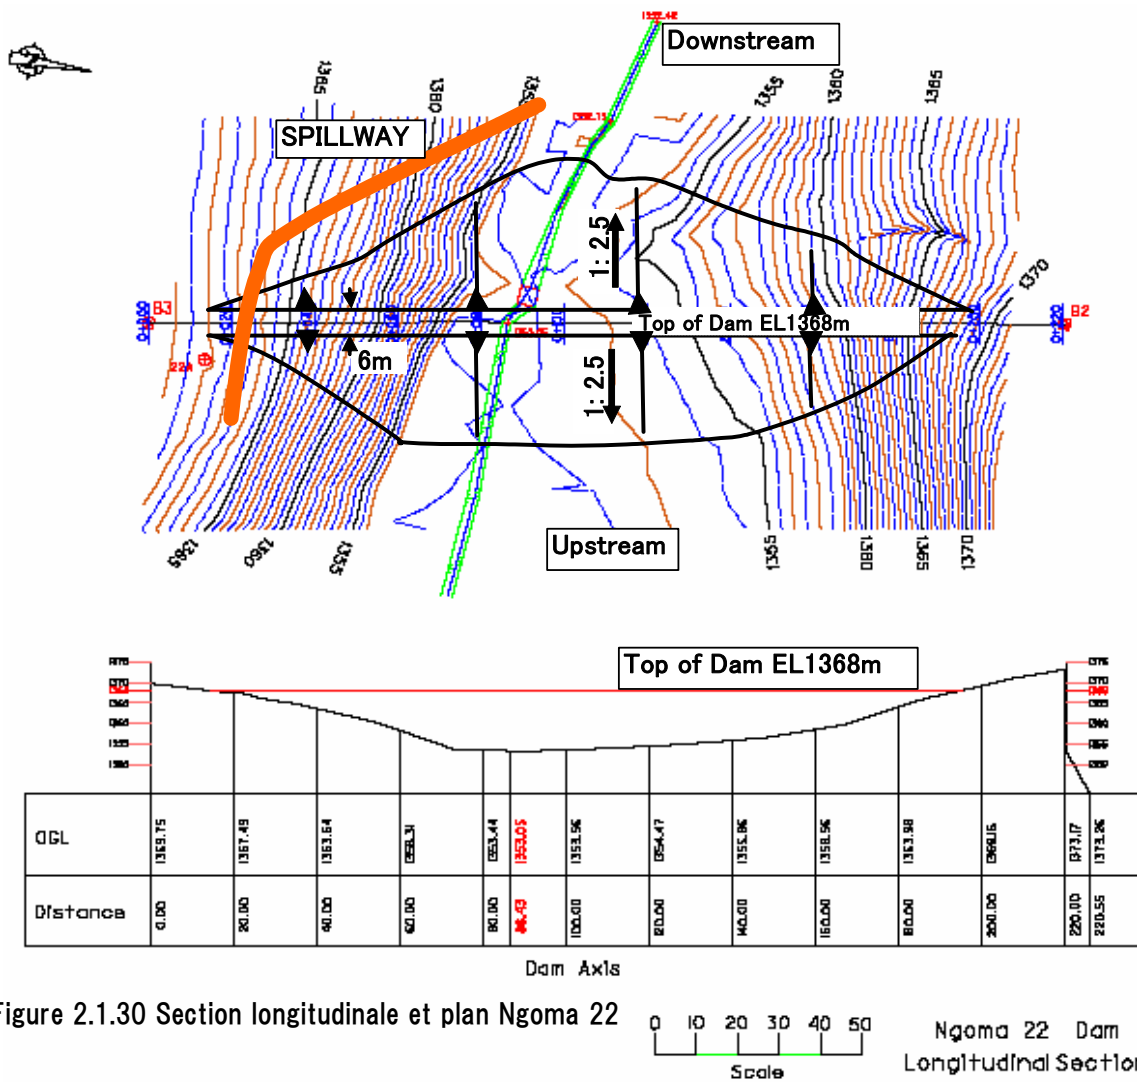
Section longitudinale et plan Ngoma 22
